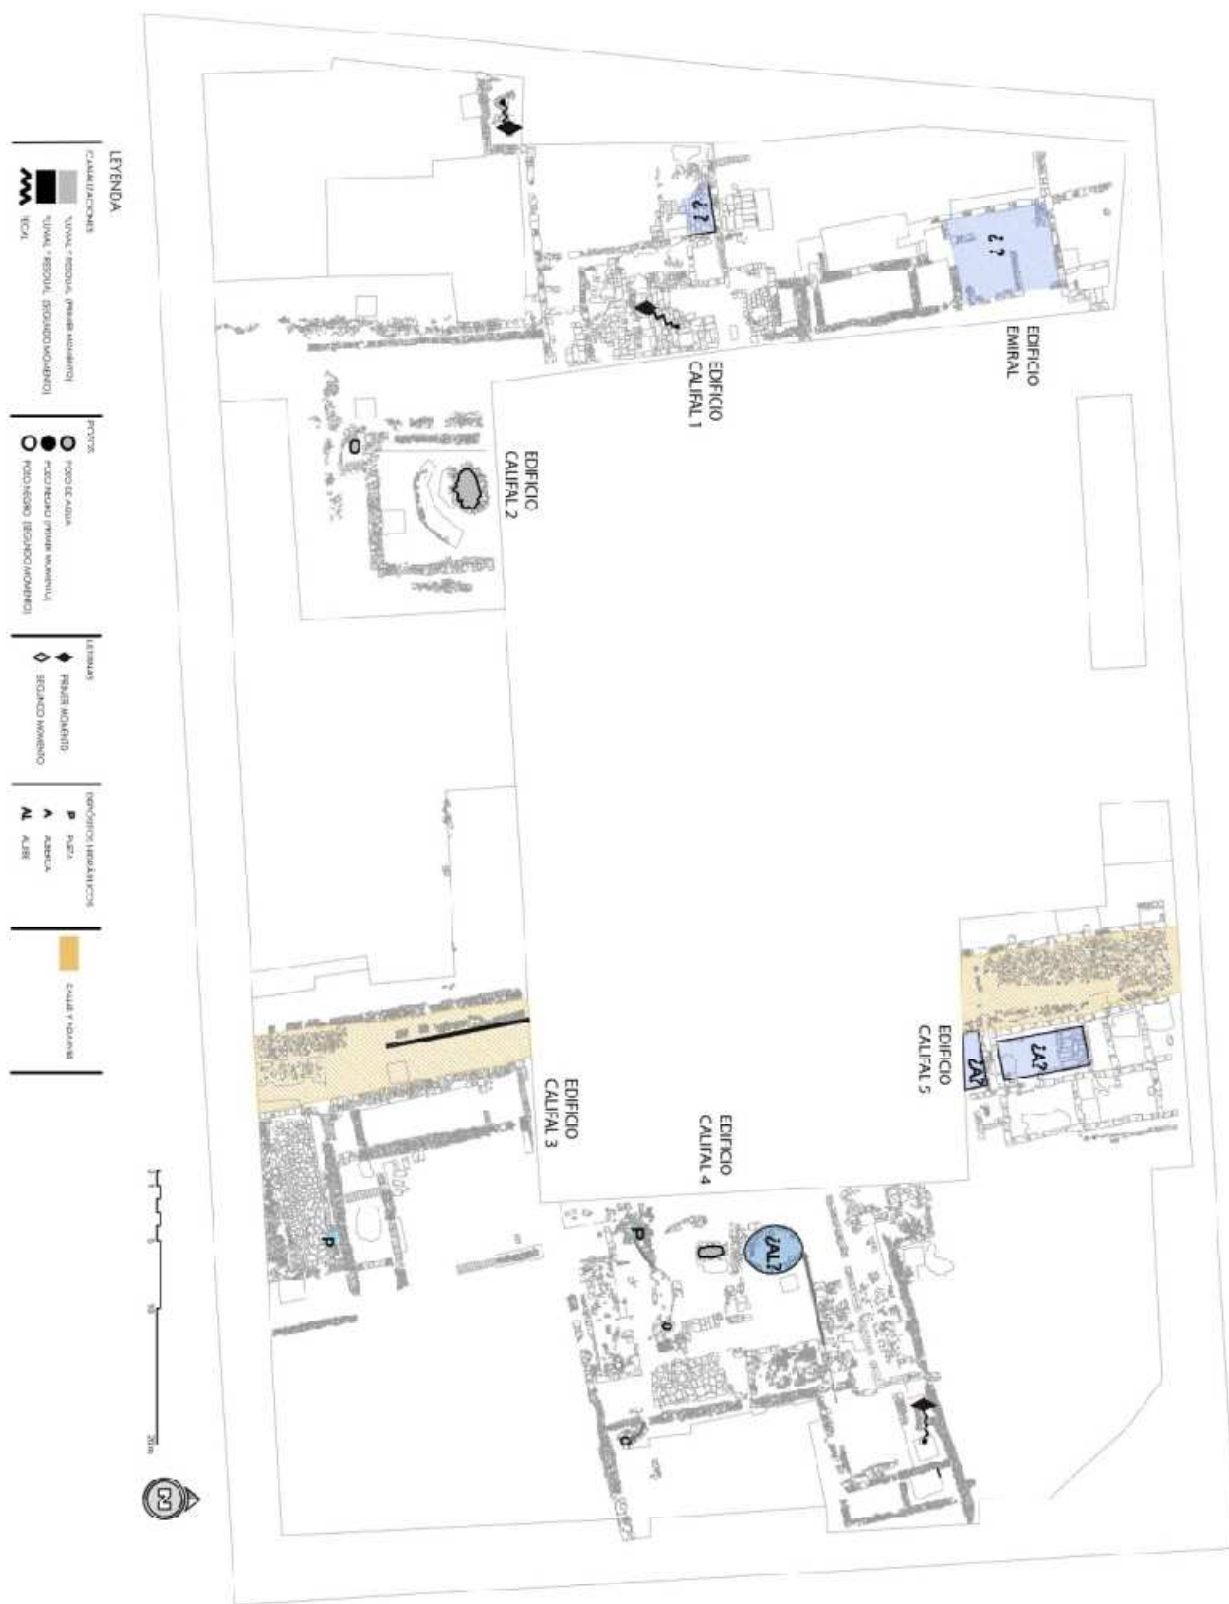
Planta general de la manzana 2 del P.P. O-7 e instalaciones hidráulicas documentadas (sobre planimetría de D. Gaspar; Molina, 2007).
